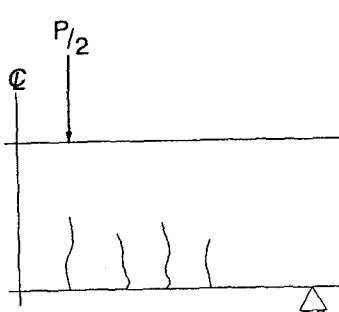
RCはりのひびわれ進展図（上部鉄筋4本）
